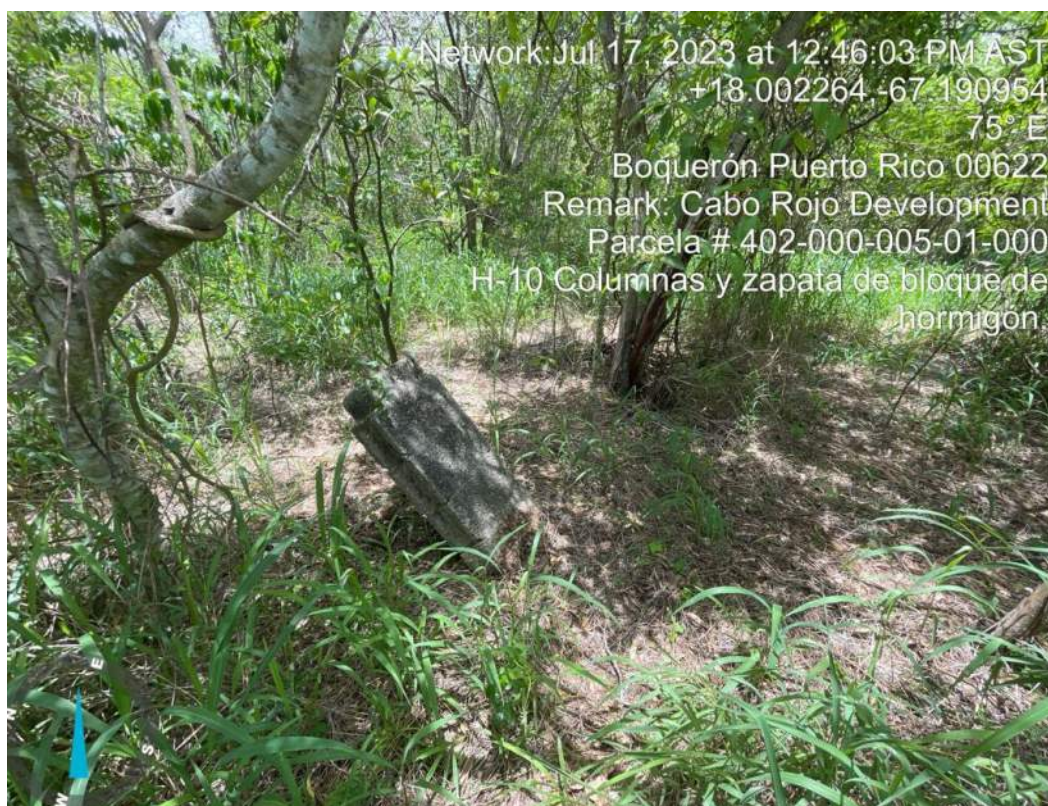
Elemento H-10, columnas y zapata de hormigón.
